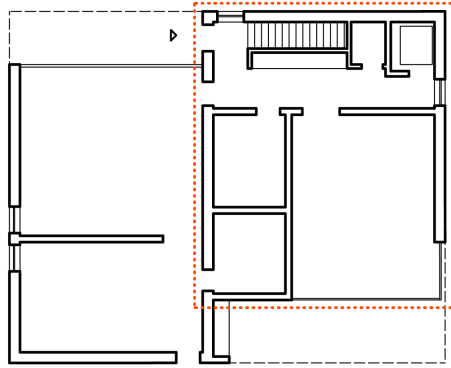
Thermische Gebäudehülle | Erdgeschoss
